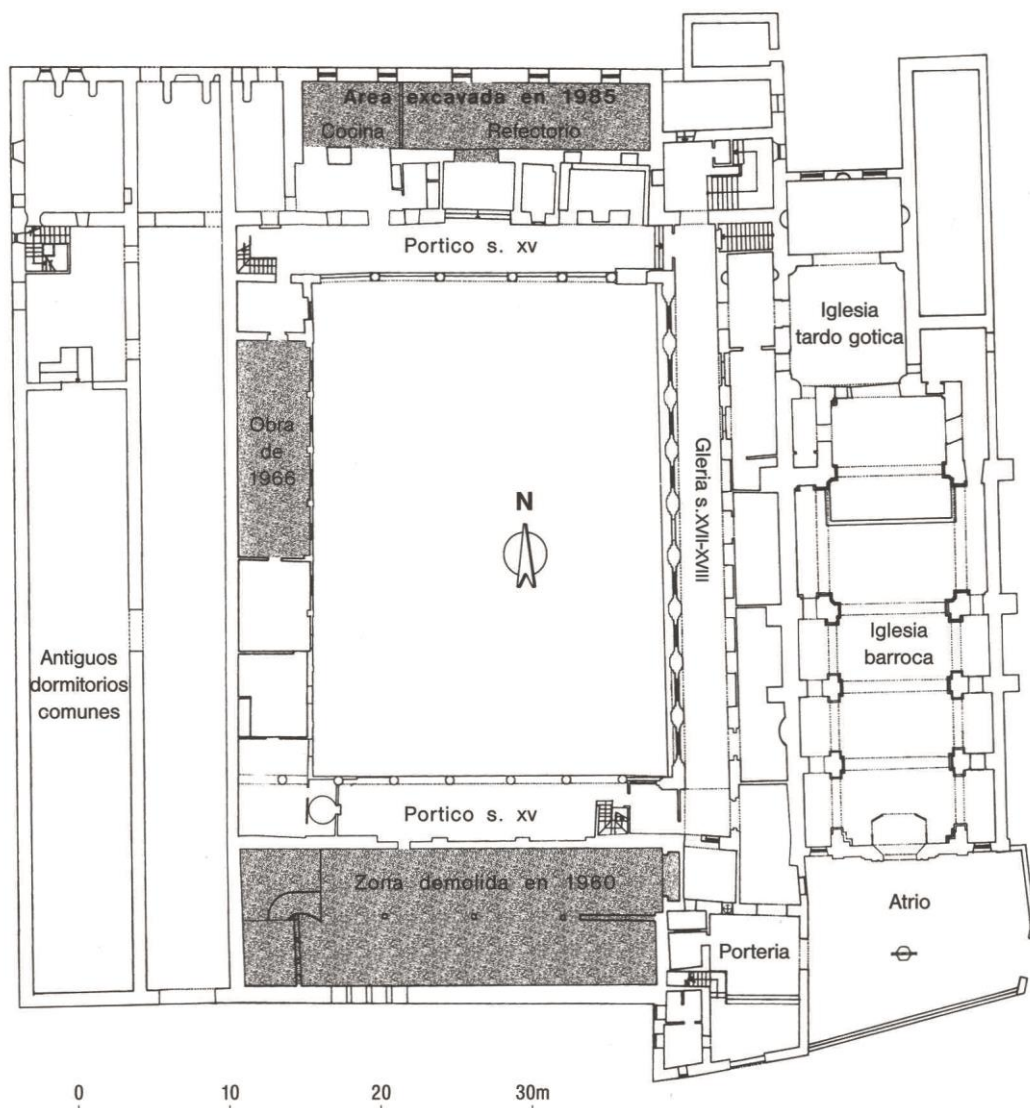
Planta actual del monasterio de Santa María la Real de Murcia. Julio Navarro Palazón.
